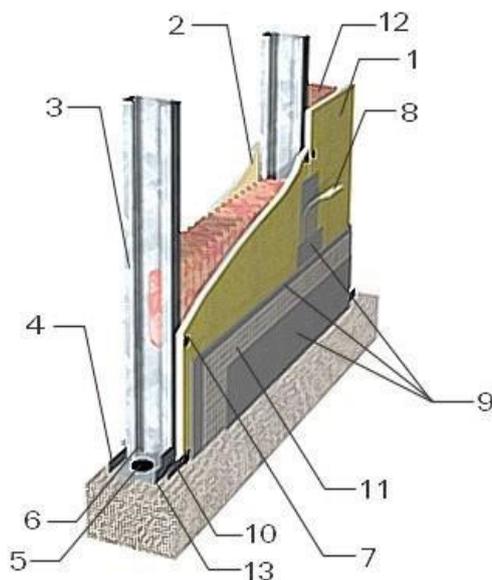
Pared con aislamiento acústico con # 1 planchas de fibrocemento
